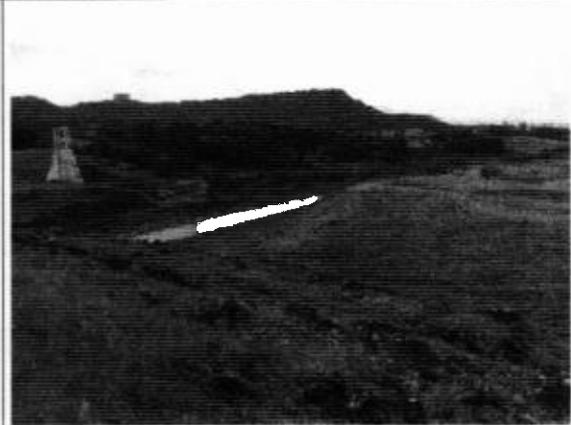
Trecho a montante. Extravaso lateral construído (a esquerda).
